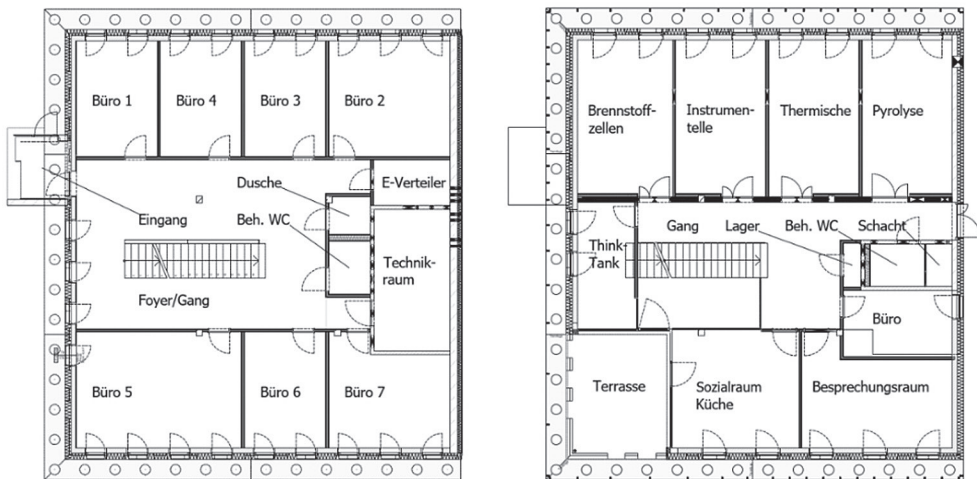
Grundriss des Gebäudes; links: Erdgeschoß, rechts: Obergeschoß
